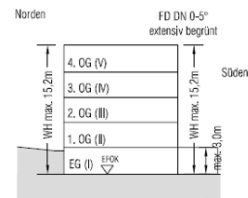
Planungsentwurf B-Plan Planstand 16.03.20.
